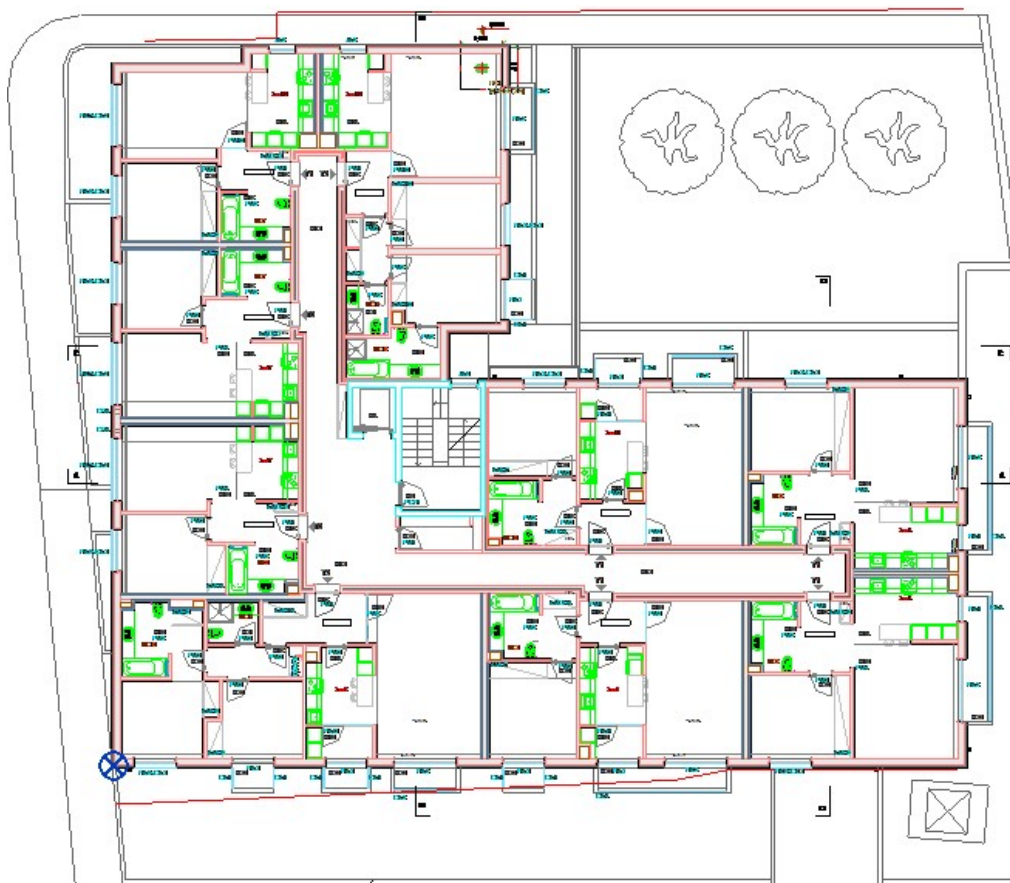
Planta do Piso 2 (Teto do Piso 1)
